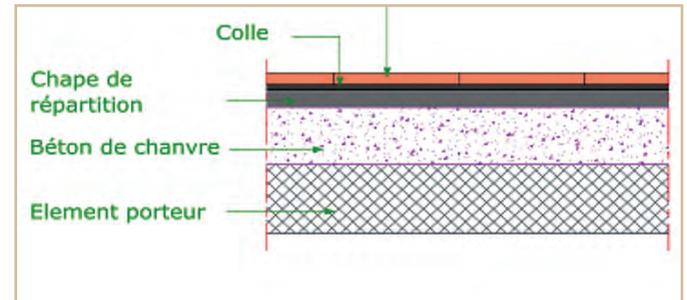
Schéma simplifié de carrelage collé sur chape sur forme de béton de chanvre
